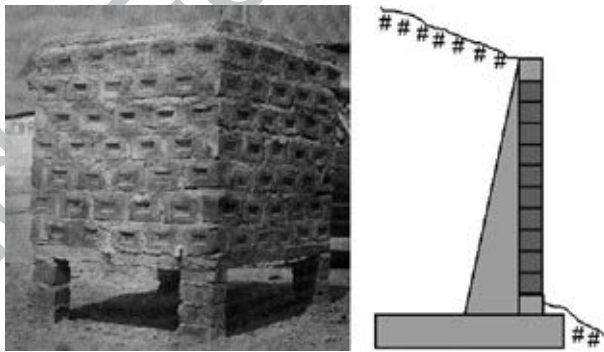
Ejemplo del mal uso de la albañilería: tanque de agua hecho de albañilería no reforzada, apoyado sobre pilas de mampostería.
